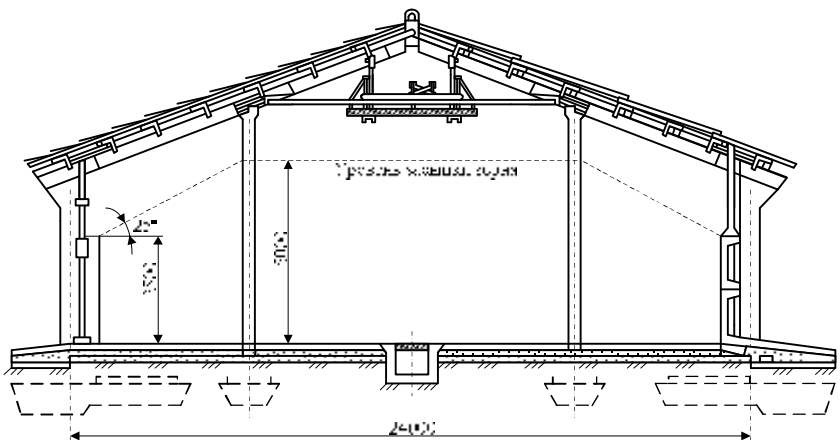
Типовой механизированный зерновой склад из сборного железобетона
